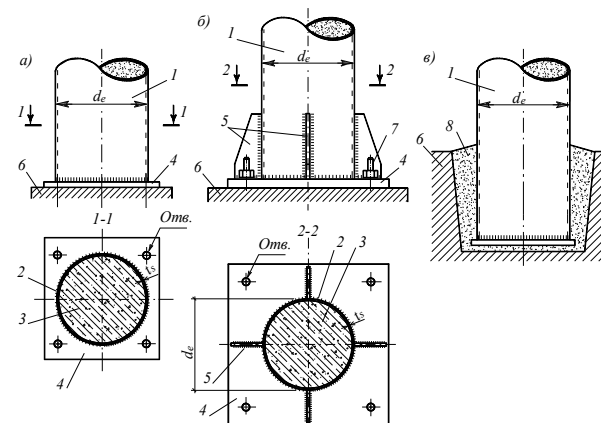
Шарнирное (а) и жесткое (б, в) соединение центрально сжатых трубобетонных колонн с фундаментом:
